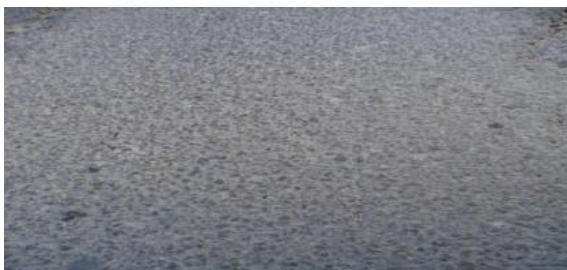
Apariencia de pavimento flexible seleccionado en Calle 80
